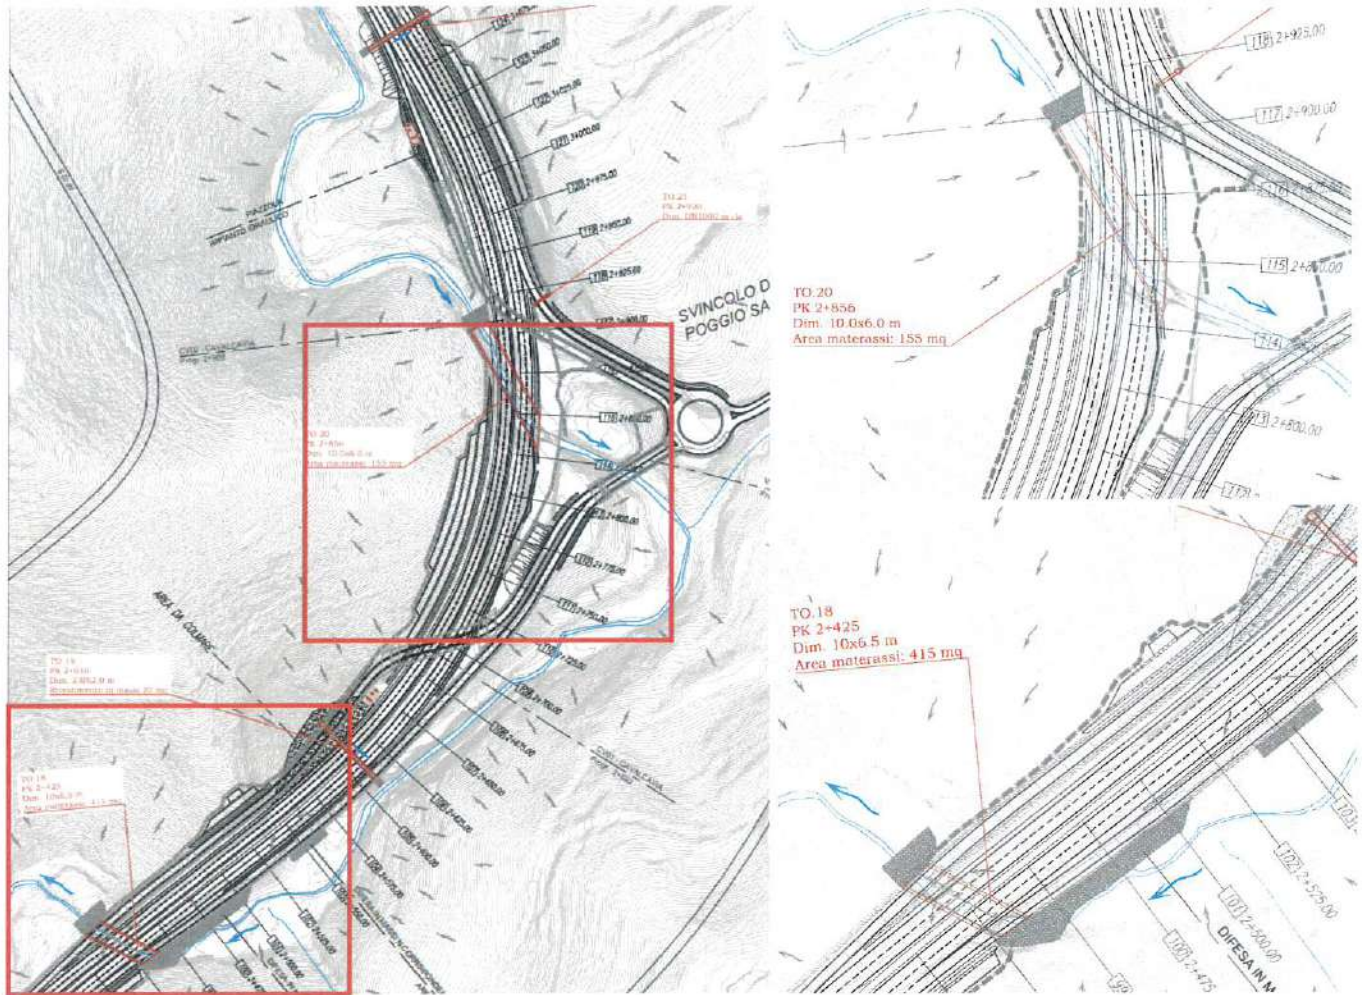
a. Svincolo poggio San Lorenzo. Attraversamento corsi d'acqua, planimetria generale e dettagli (cfr. T00ID01IDROI07A "Attraversamenti Fosso dei Cerri e affluenti - Inquadramento, planimetria - Tav. 2 di 5)
